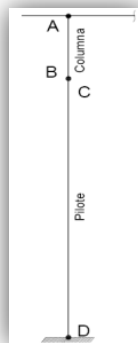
Secciones de cálculo, esquema Estribo -Columna 1-Pilote 1
